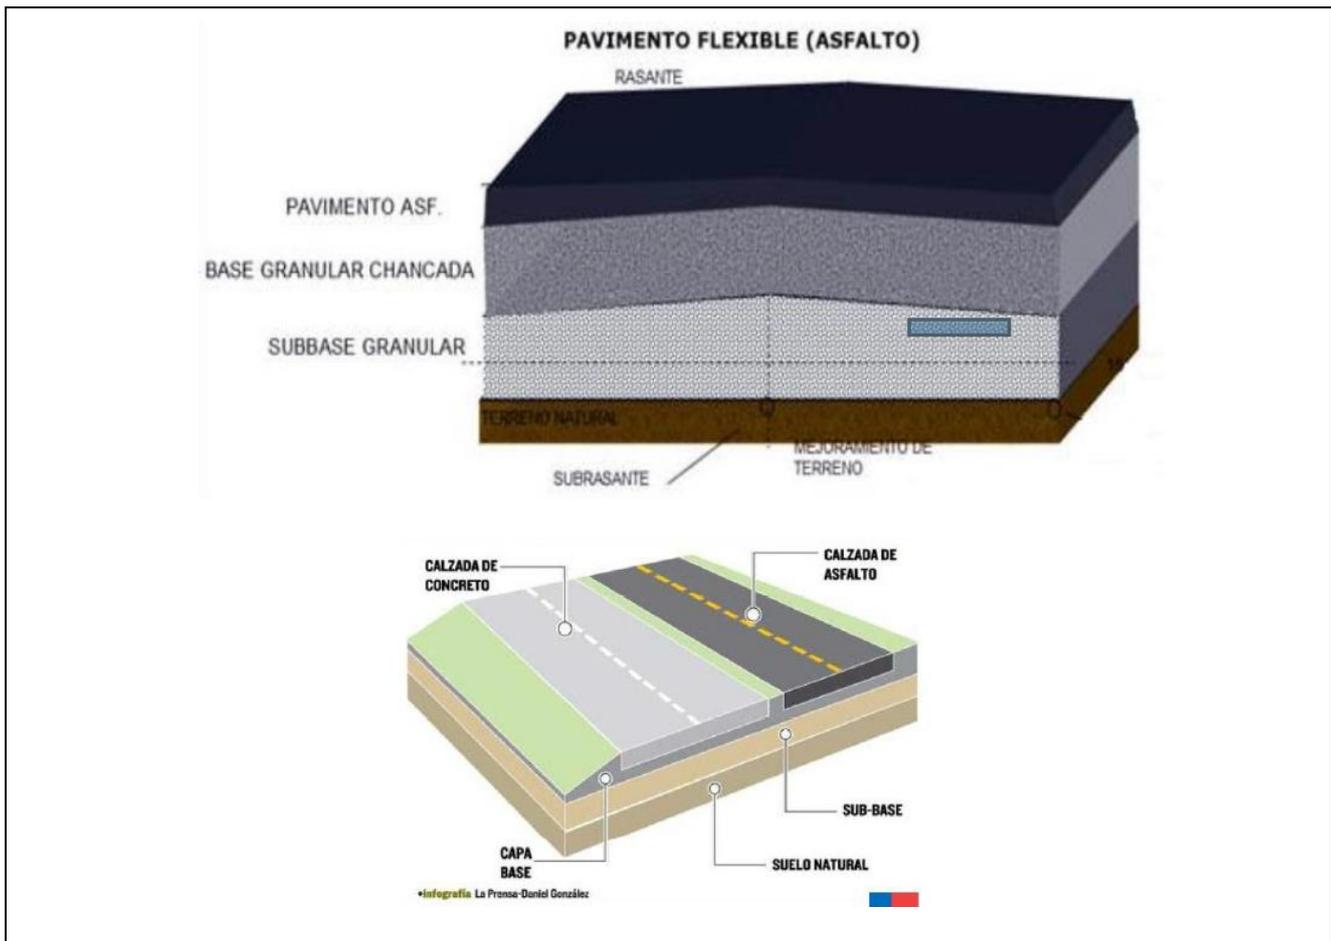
Mezclas asfálticas y estructura de carreteras¹¹.
